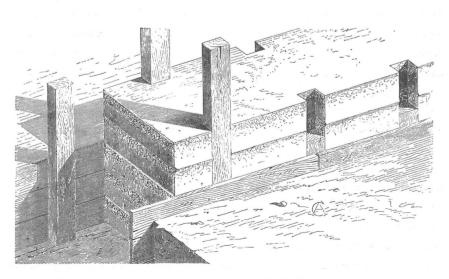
Zanja de cimentación de hormigón apisonado (jardines de la Farnesina)
